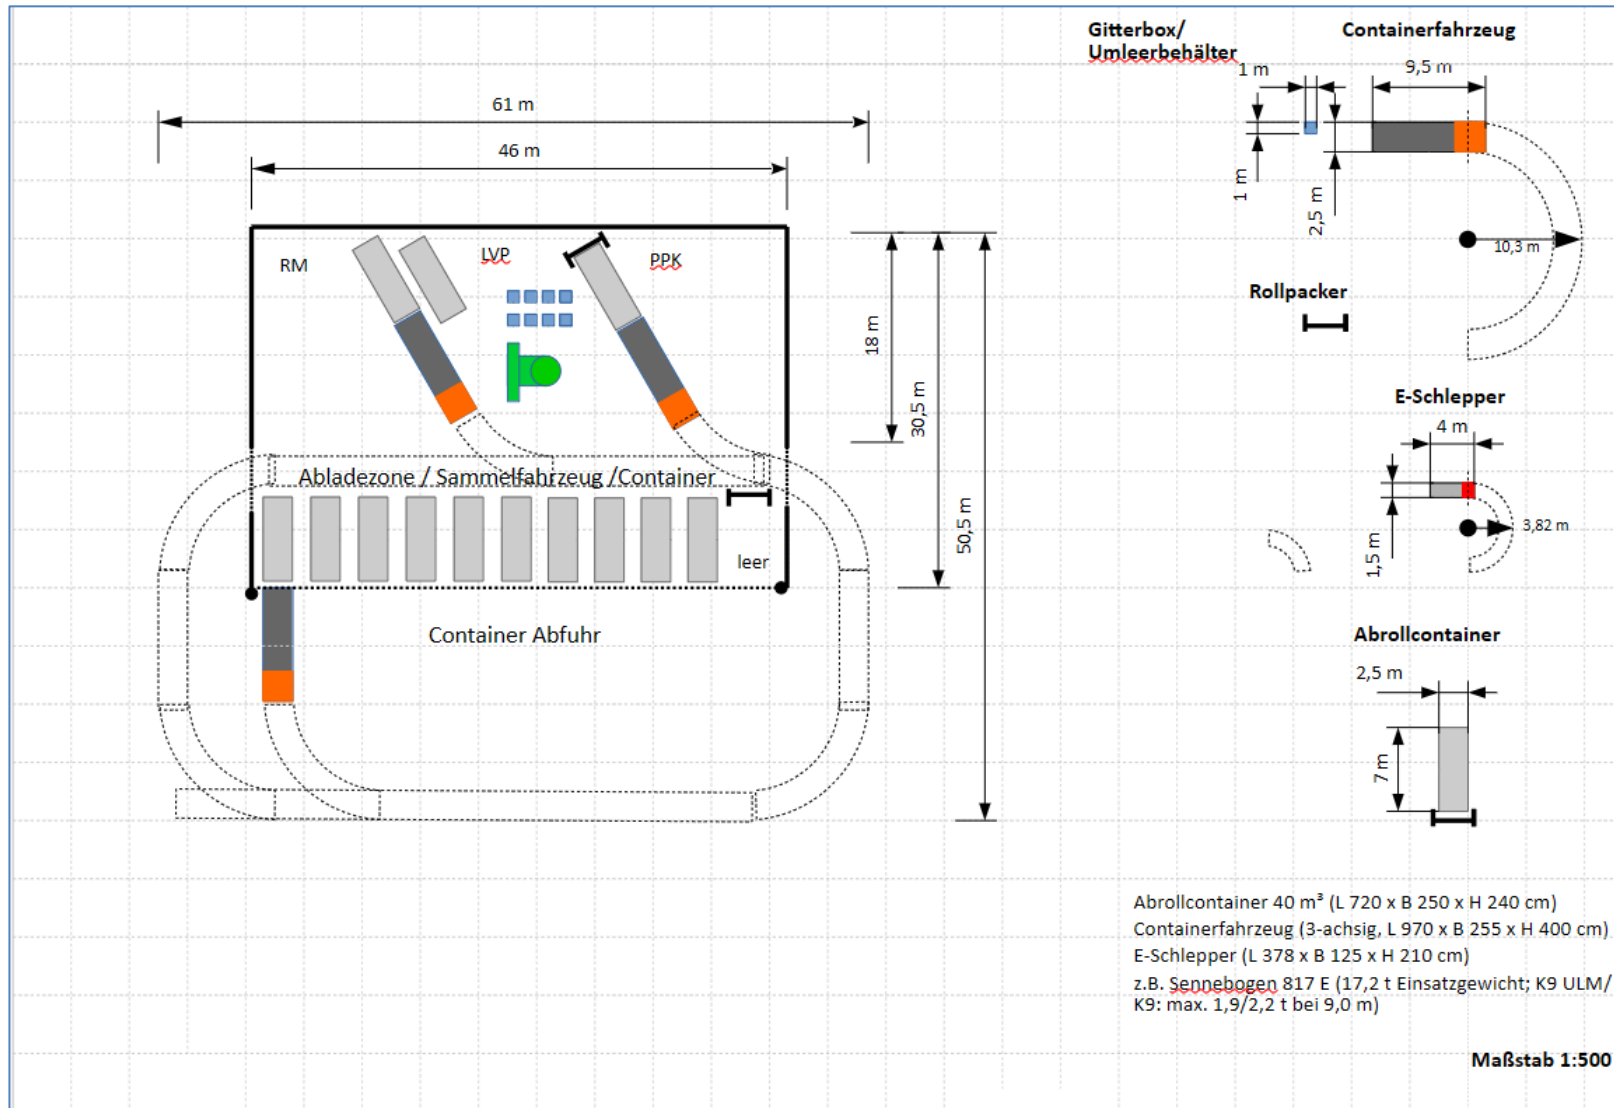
Anlagenlayout – Umschlaghalle mit Umfahrung
